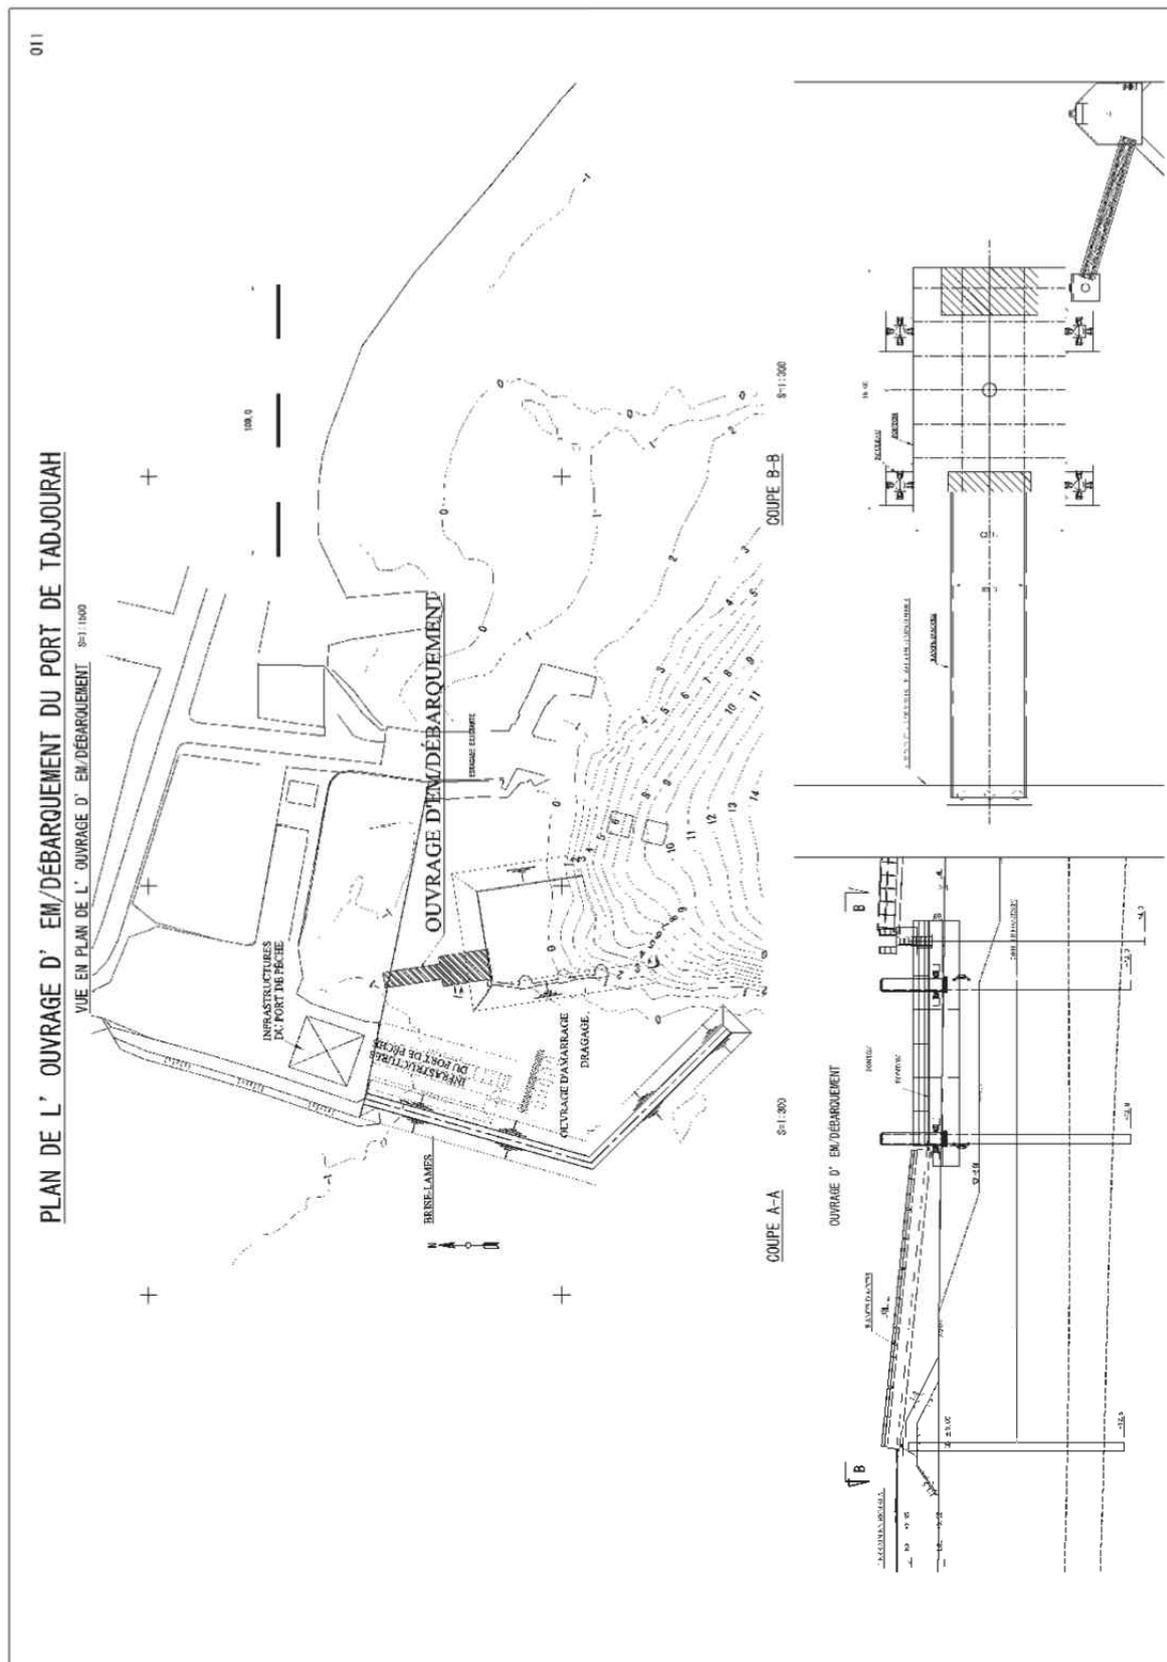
Plan de l'ouvrage d'embarquement et de débarquement du Port de Tadjourah
